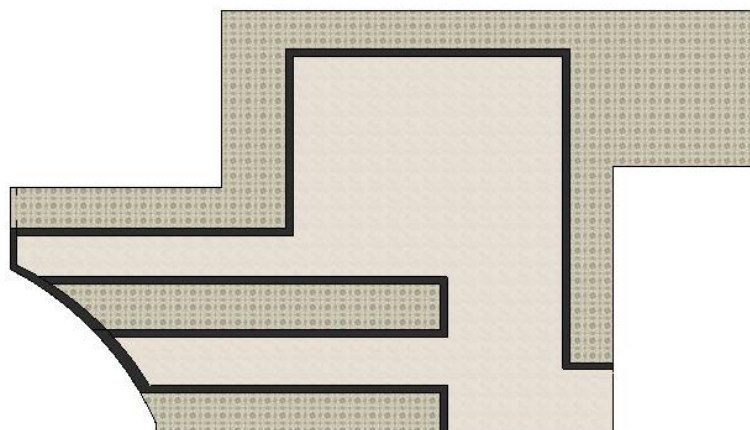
Alternatif 2 Rencana Lantai *Restaurant
